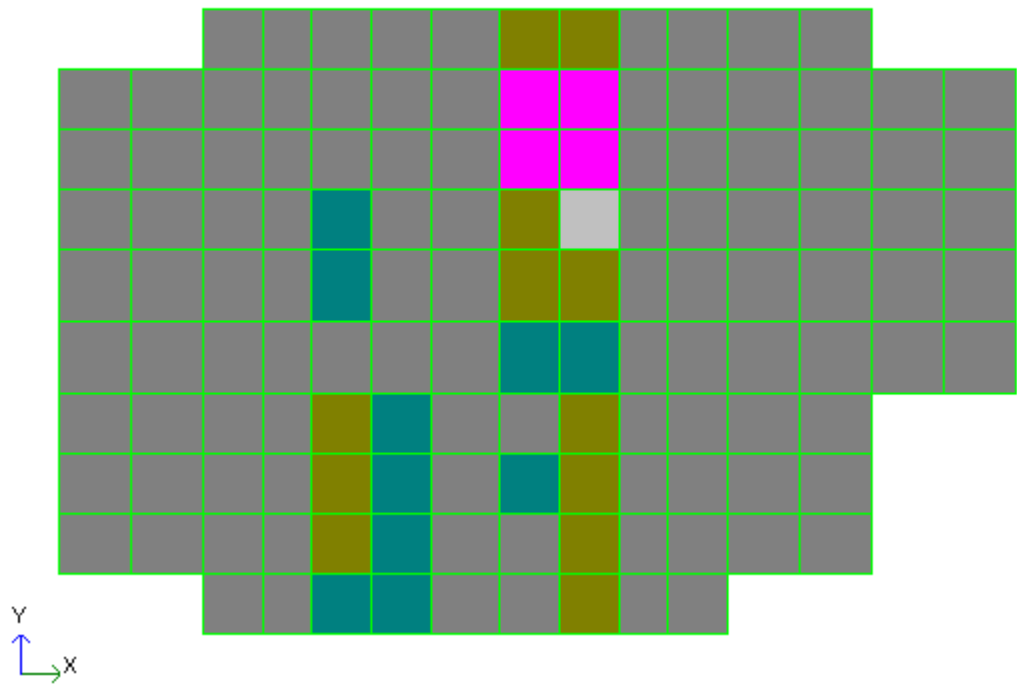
Площадь арматуры на 1 п /м по Осі X у верхній грані
